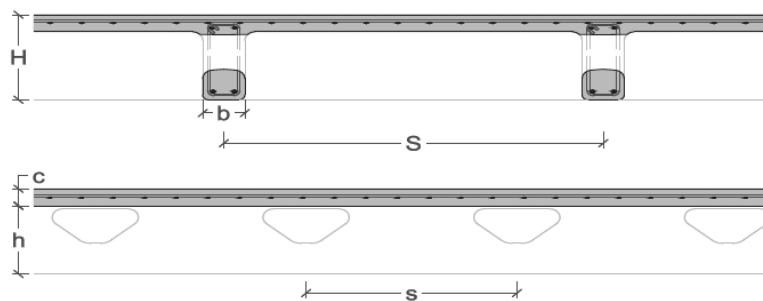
Sección constructiva forjado HOLEDECK Ho-One (HOLEDECK, 2018)
